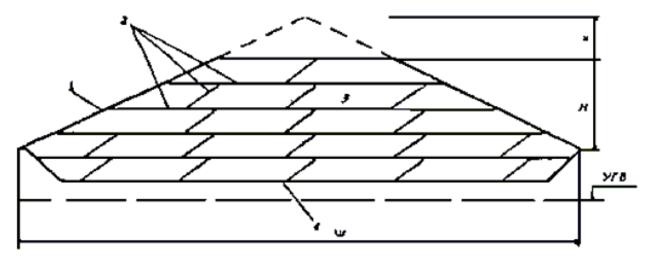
Схематический разрез полигона ТКО: 1 - наружная (окончательная) изоляция; 2 - промежуточная изоляция; 3 - ТКО; 4 - водоупорное основание; H - высота; н - показатель снижения высоты; Ш - ширина; УГВ - уровень грунтовых вод (Инструкция..., 1996)
